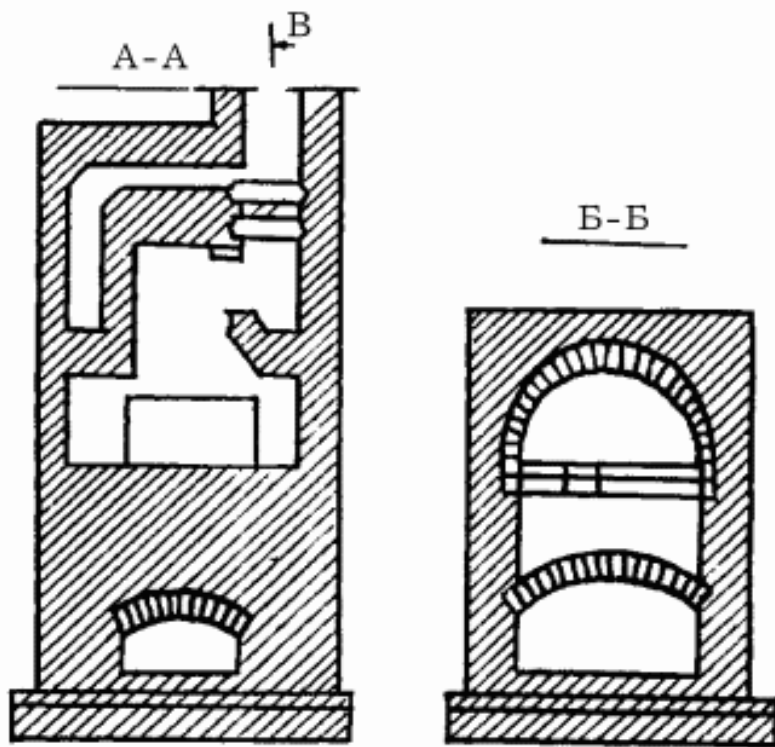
Устройство русской печи: а – подпечье; б – ниша; в – шесток; г – горнило; д – душник; е – щиток; ж – задвижки; з – дымовая труба; и – перекрыша горнила.
